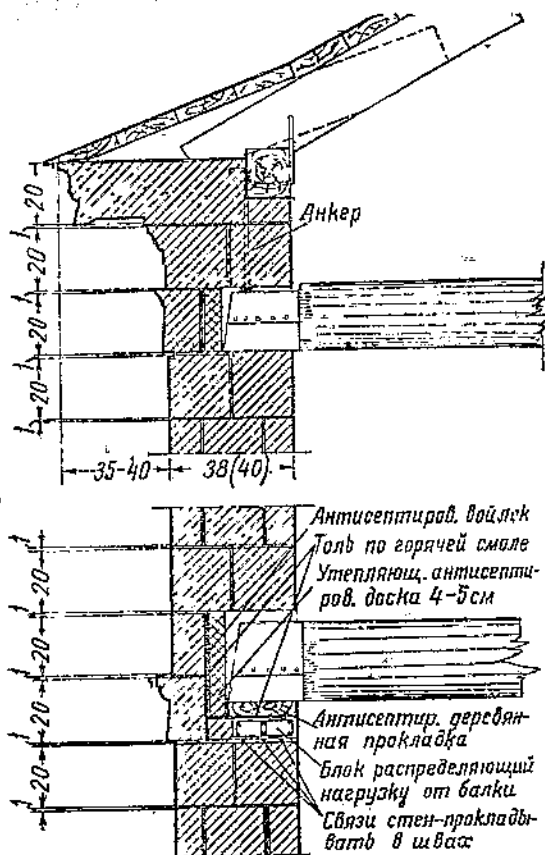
Конструктивное выполнение кладки карниза, Укладка балок на стены.
